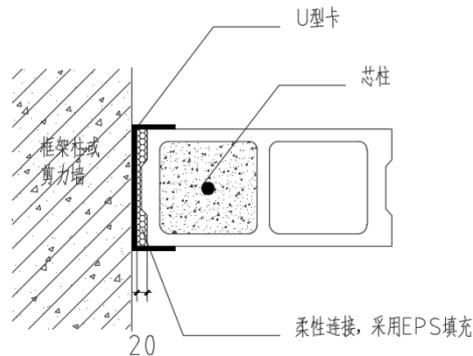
轻集料连锁免抹灰砌块内外填充墙与钢筋混凝土主体结构连接示意二
